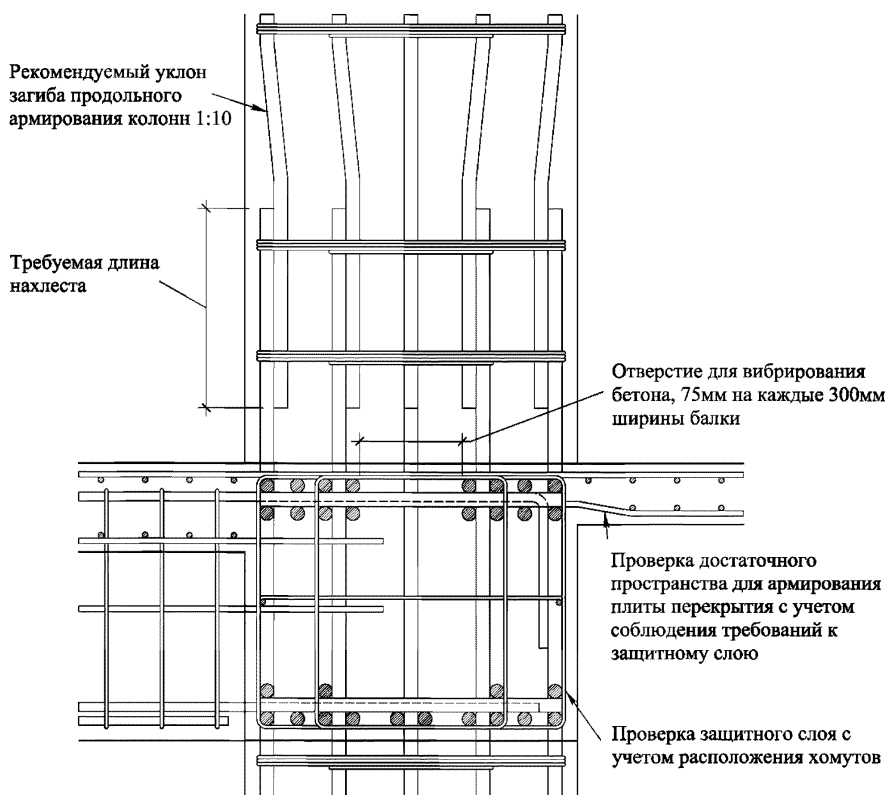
Разрез армирования узла пересечения колонны с балками
